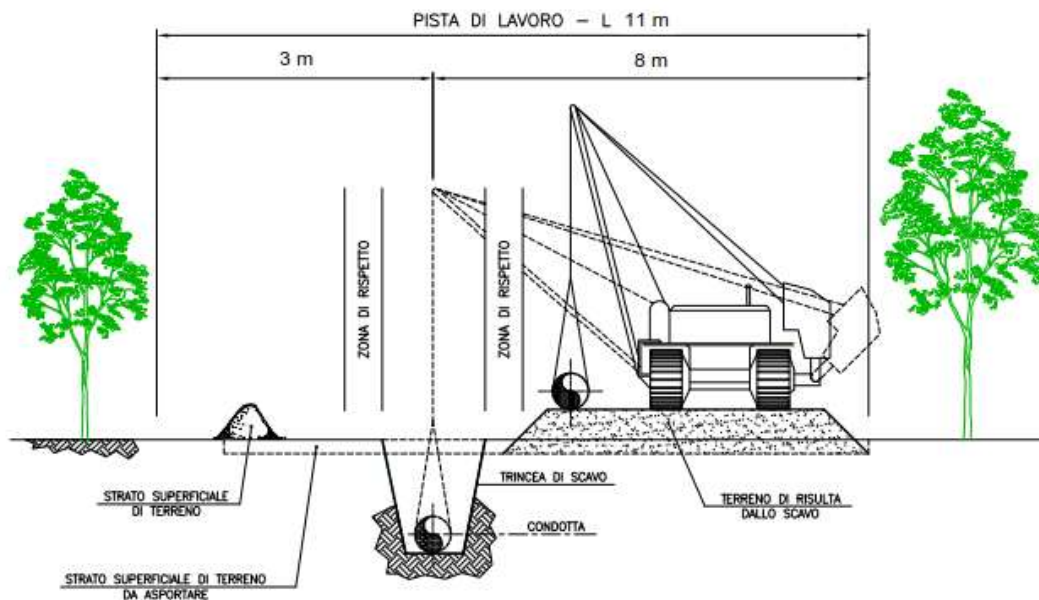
Sezione tipica - Pista di lavoro “ristretta”
